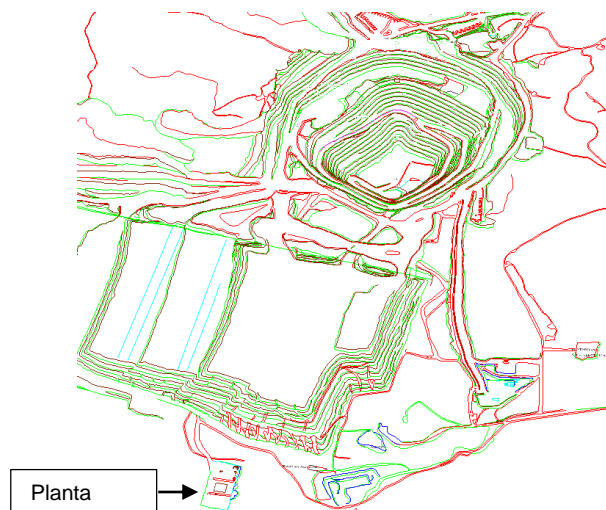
Vista Isométrica Pit Fortuna y Planta Orca
